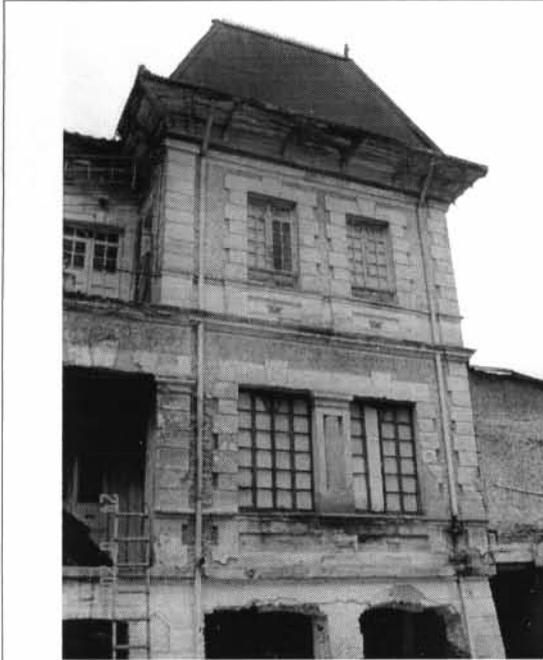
Estado de la fachada posterior de la edificación, se aprecia pérdida del pañete de recubrimiento.
